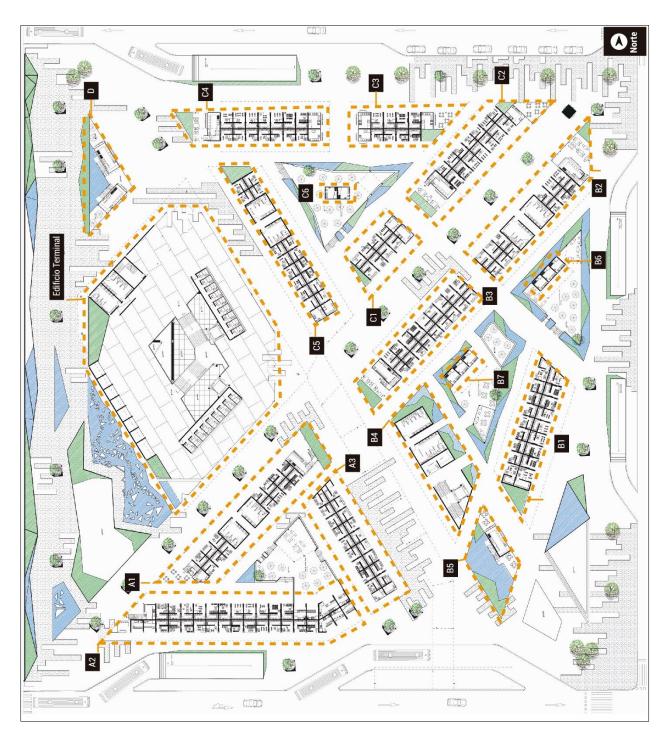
Esquema de programa Arquitectónico en planta baja Fuente: Autor
